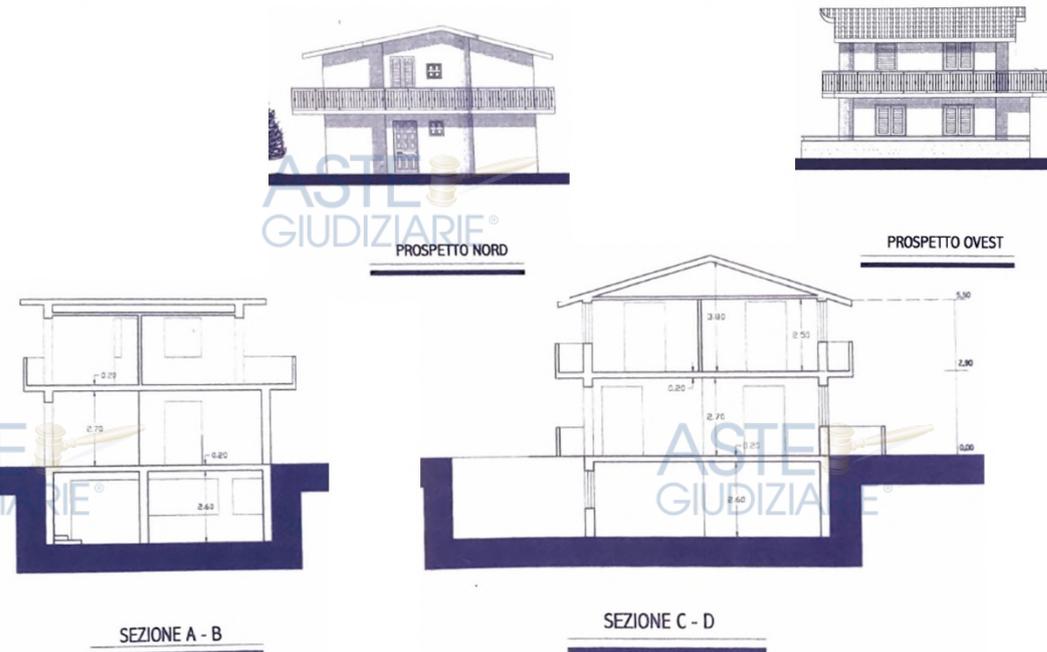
Stralcio Prospetti e Sezioni Progetto Approvato dalla commissione edilizia comunale il 04/06/2001 di cui non è stata mai rilasciata concessione edilizia in variante (Allegato 5C/3) —
